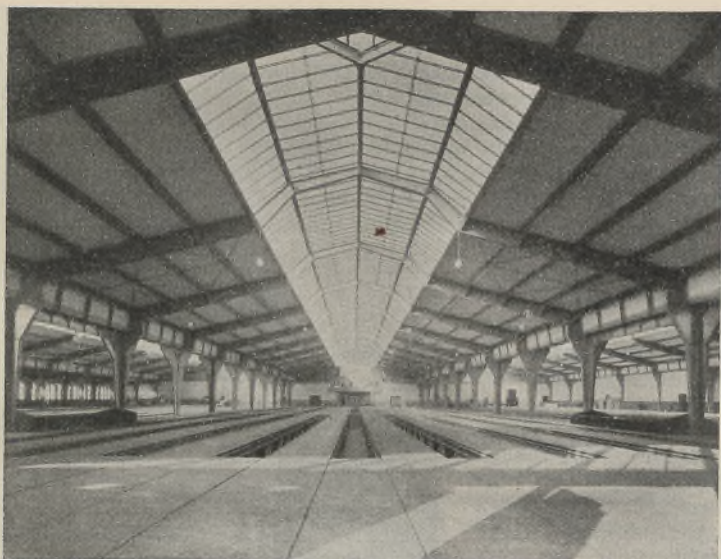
Straßenbahnhalle an der Müllerstraße, Berlin. Gesamt-Innenansicht. (Ausführung Thyssen & Co., Berlin.)
